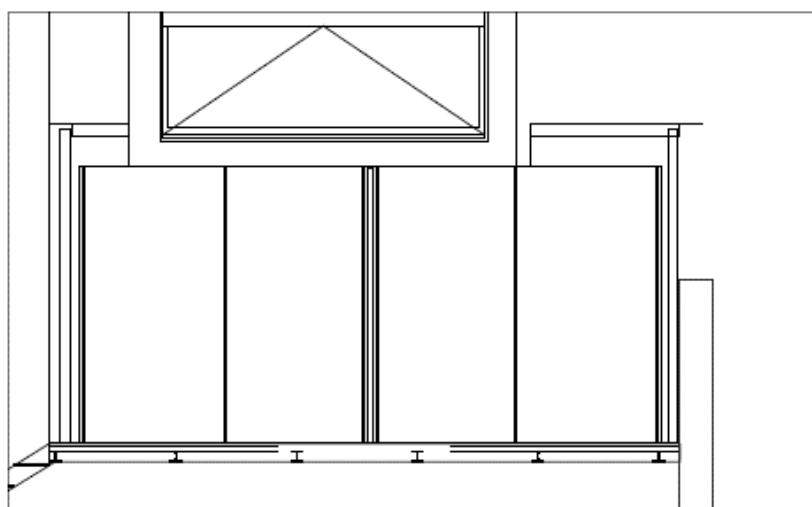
Planta do edifício Gaia: alçado piso 0
